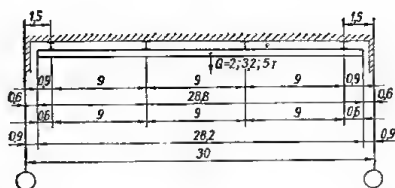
Схемы расположения подвесных кранов в зданиях с пролетом 30 м.
